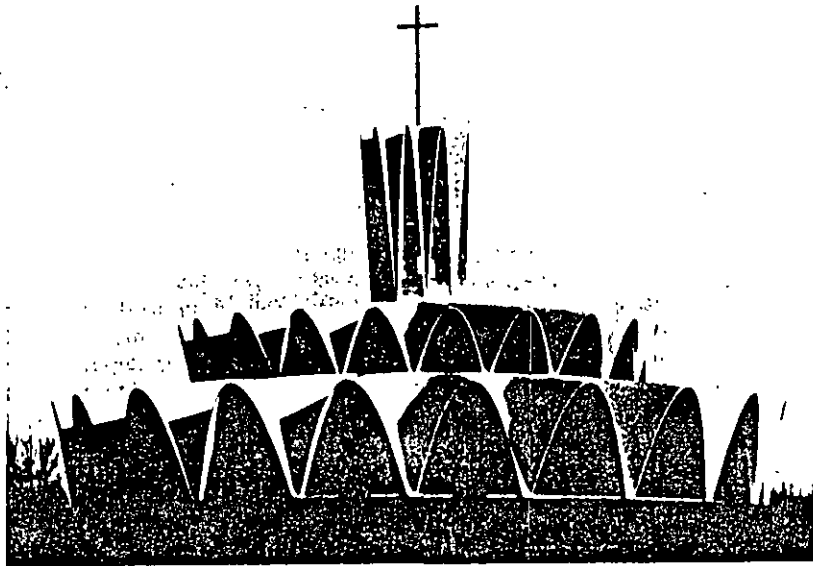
Este cascarón ondulante de hormigón se cubrió con neopreno después de hacerlo con hormigón proyectado y luego recibió una capa de pintura de base plástica.
